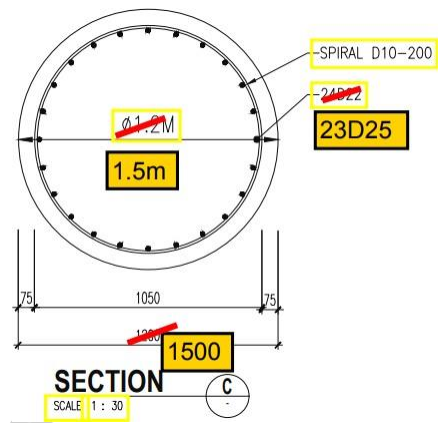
45 Shop drawing detail tulangan bored pile type G section D
